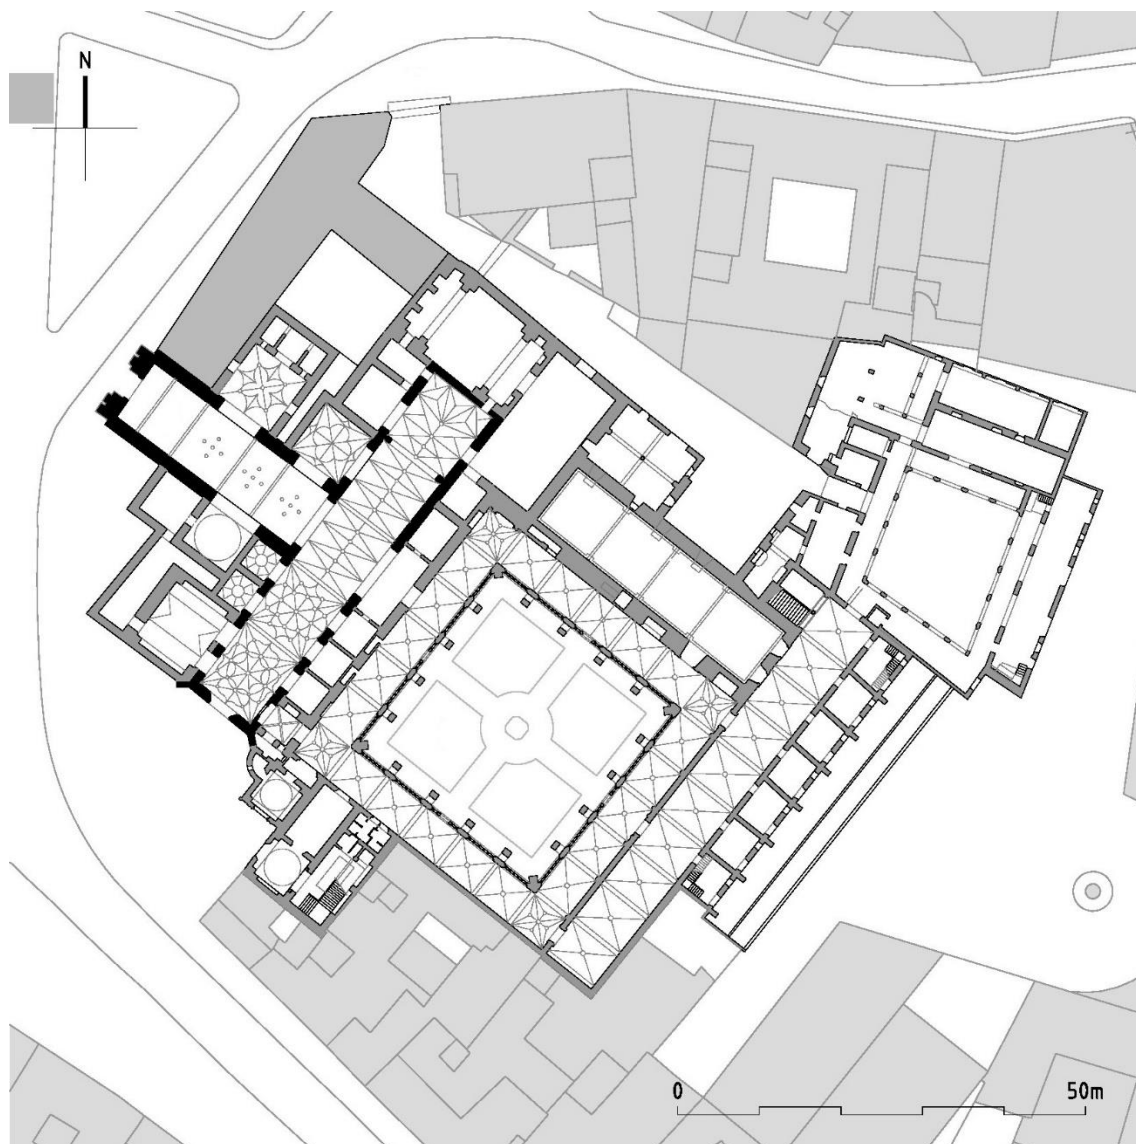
Planta general del conjunto. Monasterio de Santo Domingo. Jerez.
